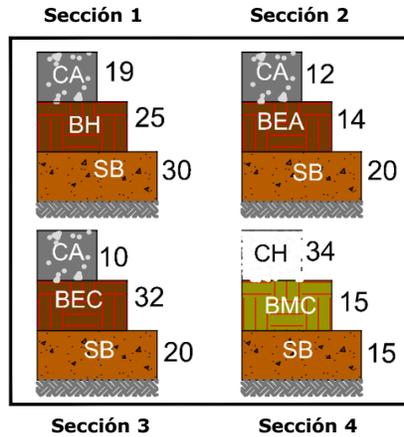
Detalle de las secciones aplicables a la carretera mencionada en el ejemplo
